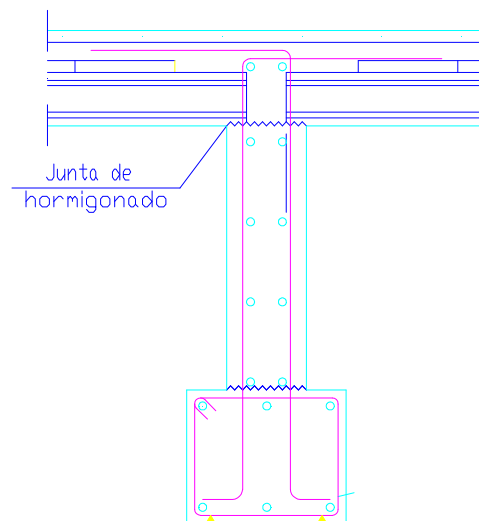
Detalle encuentro forjado sanitario cimentación
